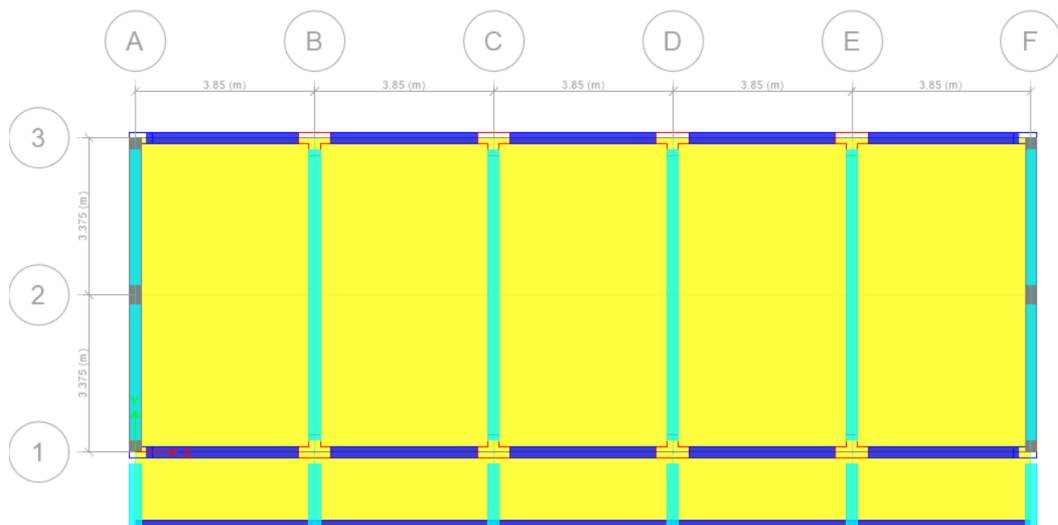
Vista en planta en Software Etabs (Aulas + Laboratorio)
